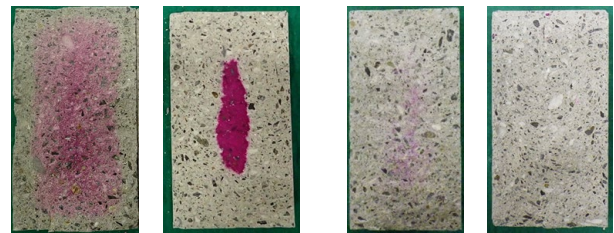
炭酸化 7 日 写真-2 炭酸化 28 日
